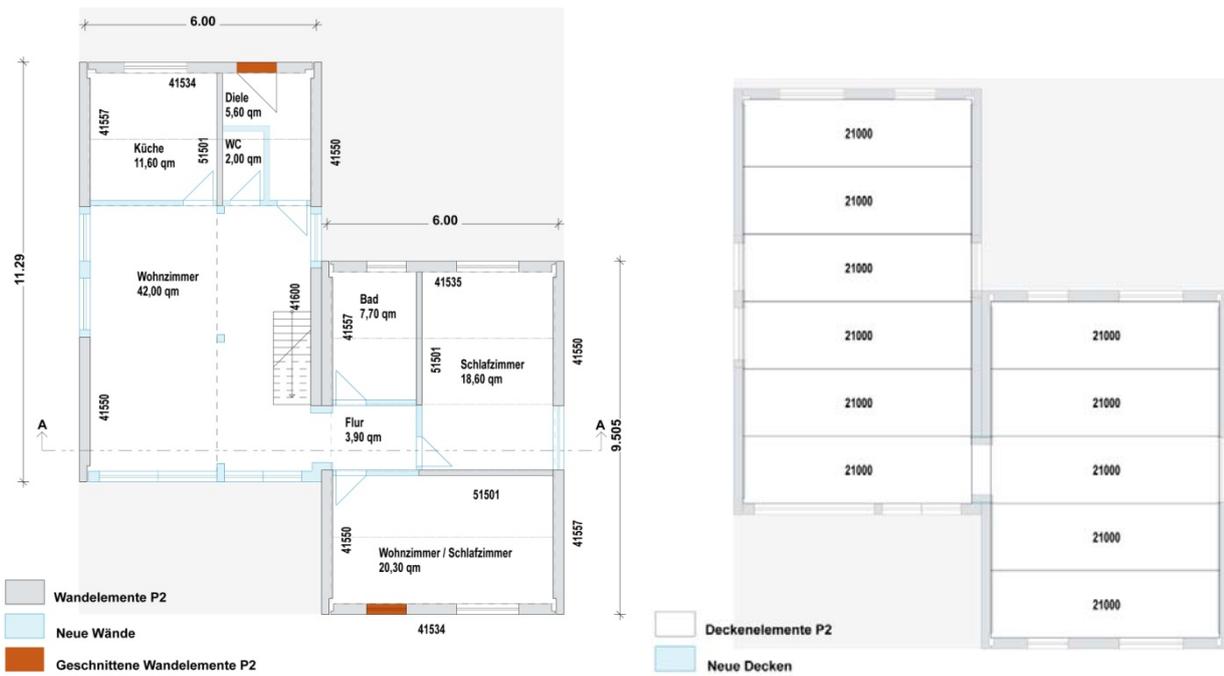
Grundriss Erdgeschoss (Variante 1 und 2)
